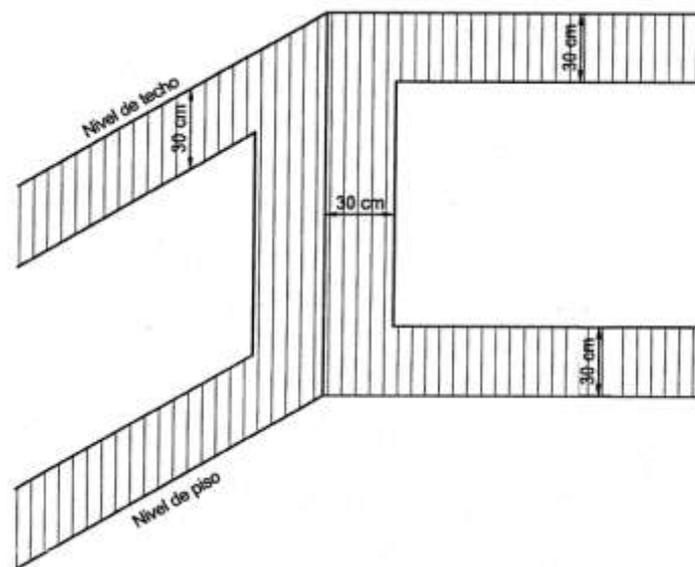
Zona de trazado de instalaciones de tuberías empotradas
